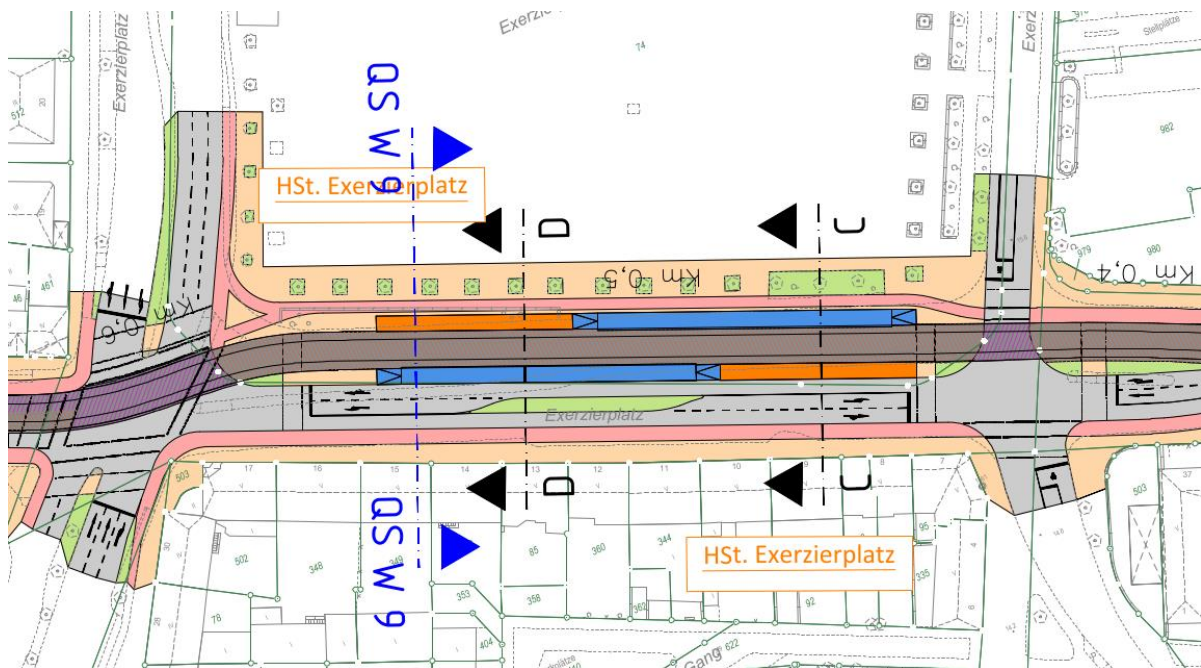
Beispieldarstellung Lageplan Exerzierplatz.
